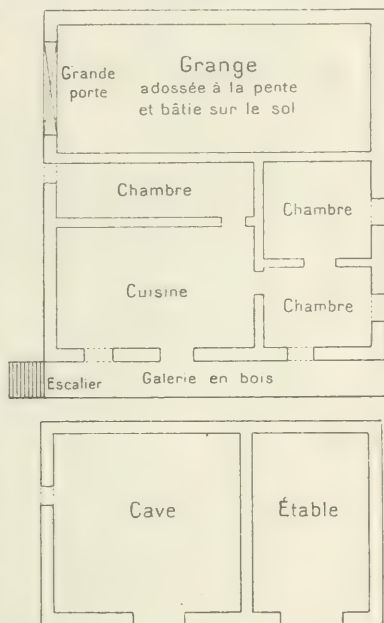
Maison en hauteur. Ferme des Guichards (Vaulnaveys, près d'Uriage (Isère). — En haut, 1^{er} étage, 9 m. sur 9 m. En bas, sous-sol, 9 m. sur 5 m. D'après un dessin de M^{lle} Foncin.
